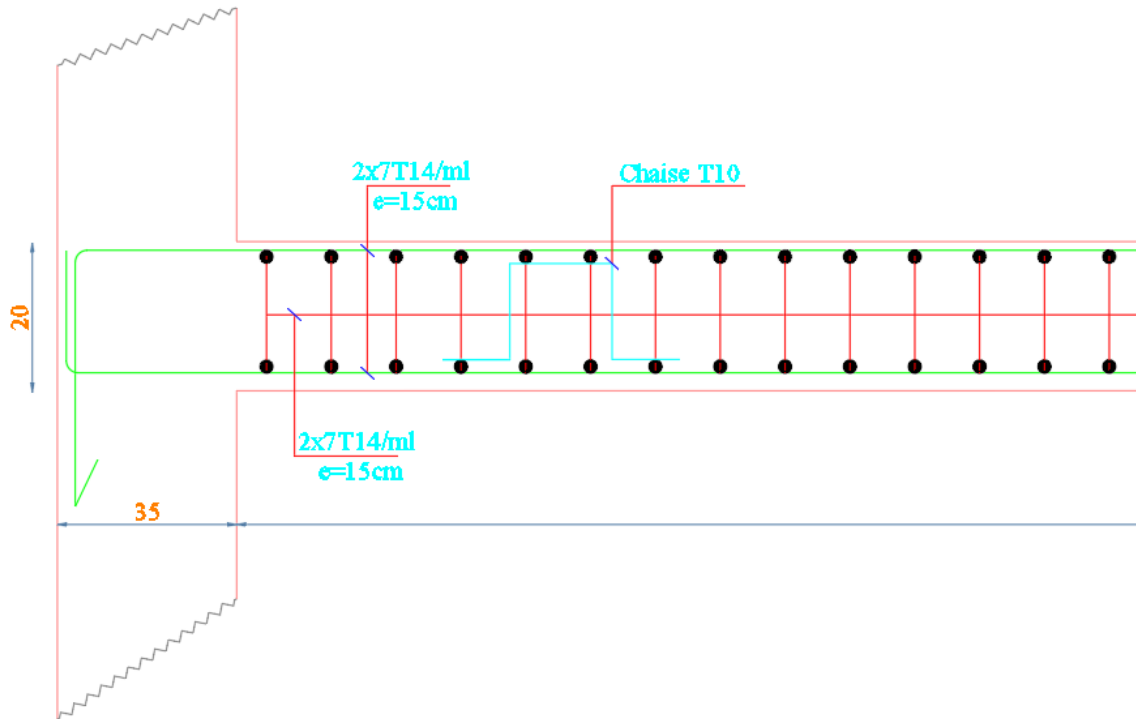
Schéma de ferrailage de la dalle de la terrasse.
